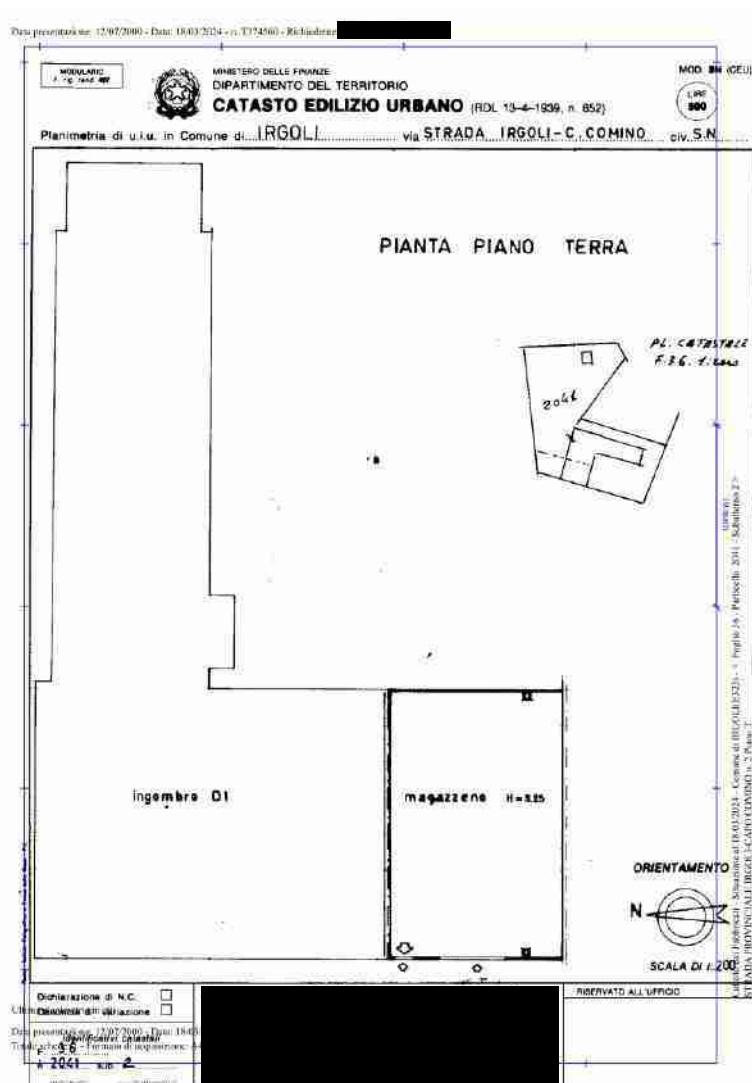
\_planimetria catastale del f.36 p.lla 2041 sub.2 (magazzino)
